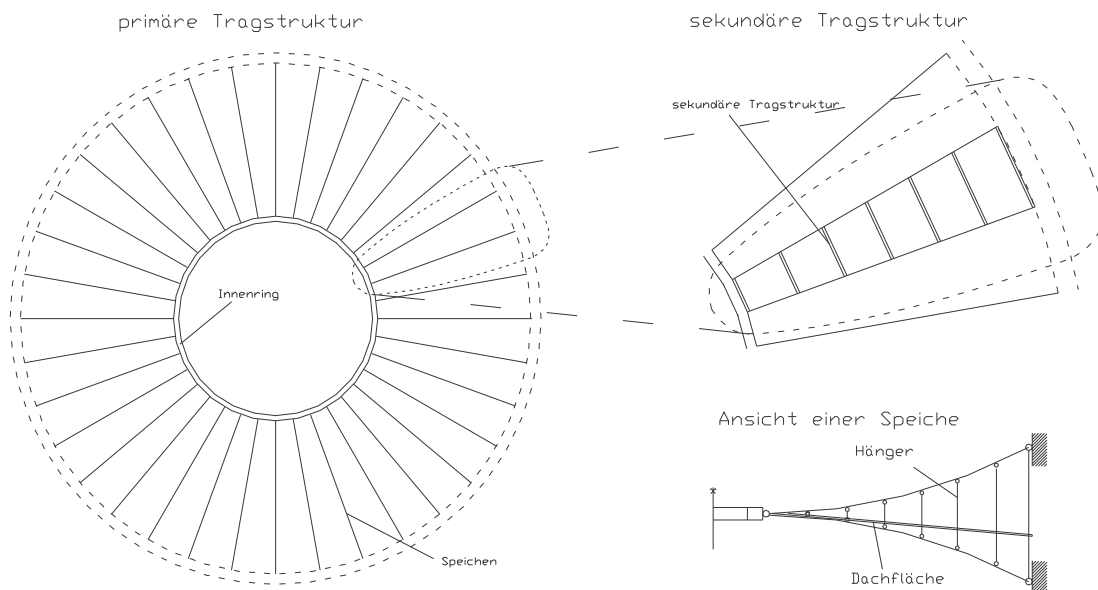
Grundriss des betrachteten Systems, Lage der sekundären Tragstruktur und Ansicht einer Speiche
